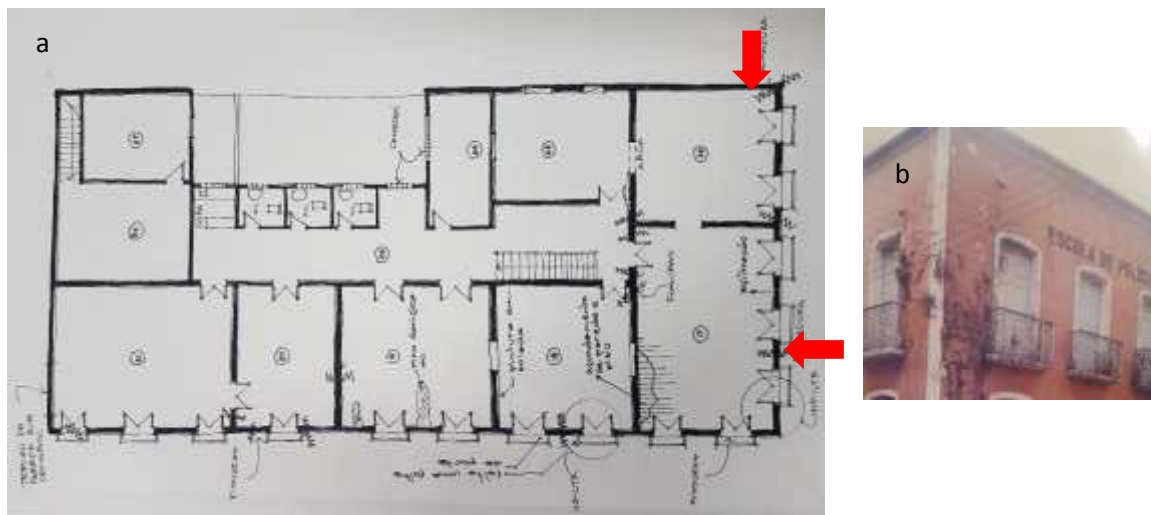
Rua da Palma, n.º 336. (a) Croqui do primeiro pavimento realizado em vistoria técnica pelo IPHAN em 1995. (b) Detalhe de rachadura em 1996.
